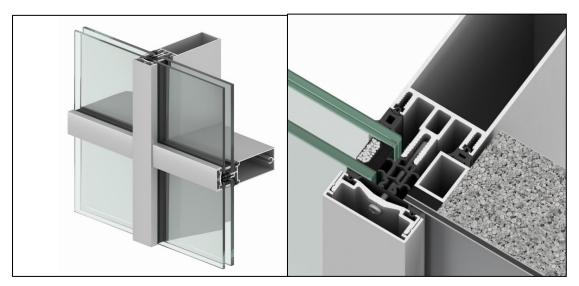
Modelo de muro cortina del proyecto a utilizar.
